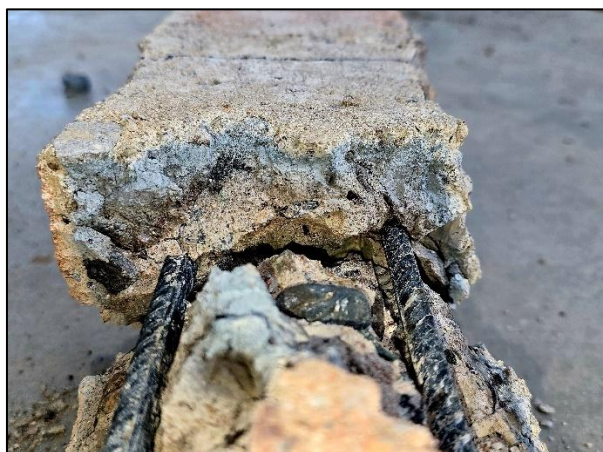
Cambio de coloración por capas de concreto en sección de viga V-CTE
